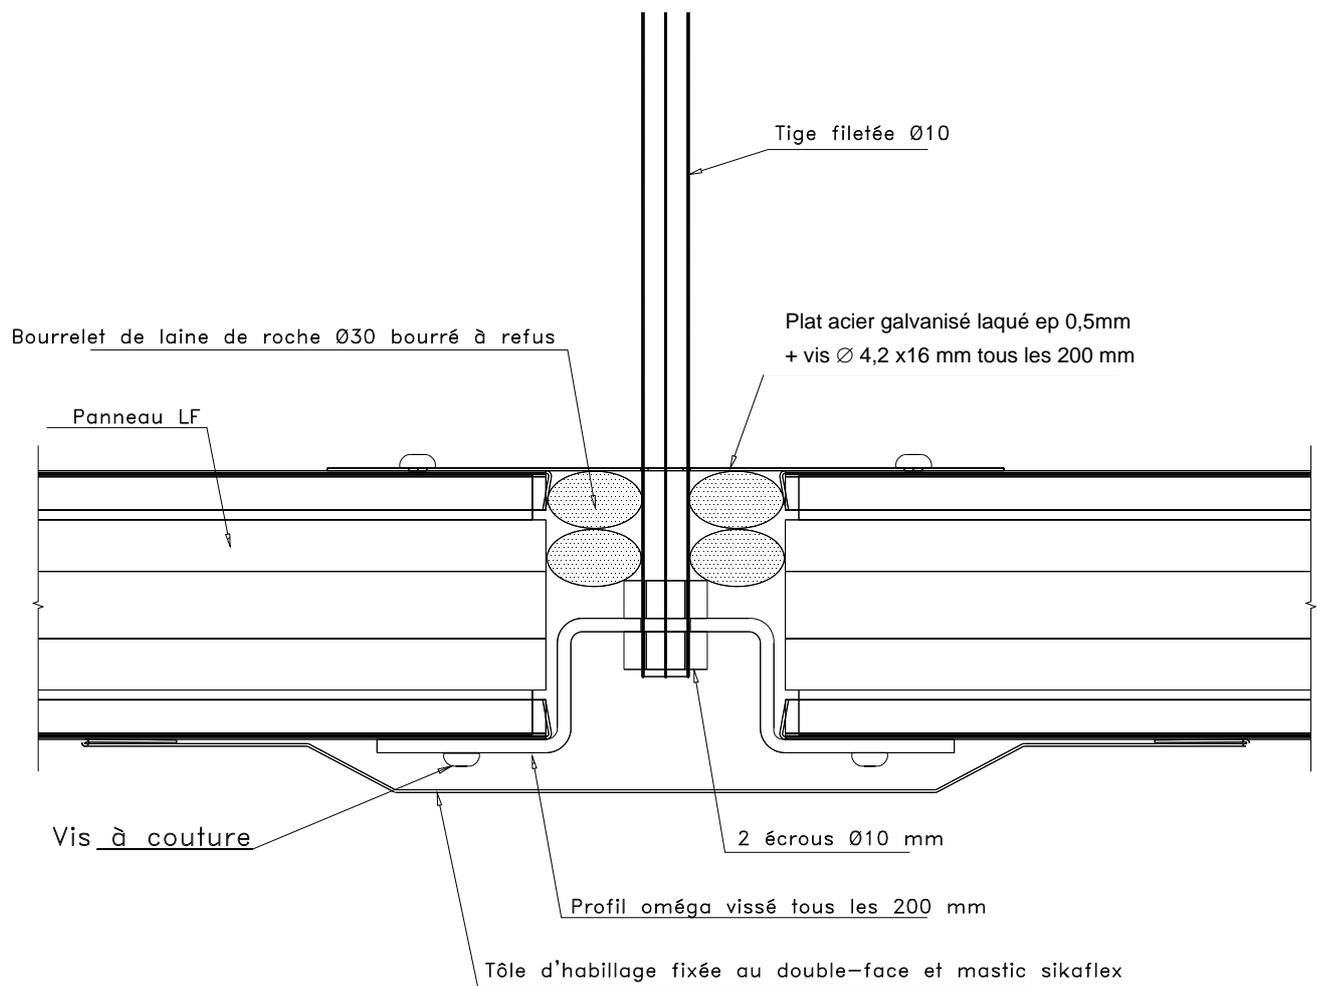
Pose sur oméga porteur des panneaux LF en plafond
